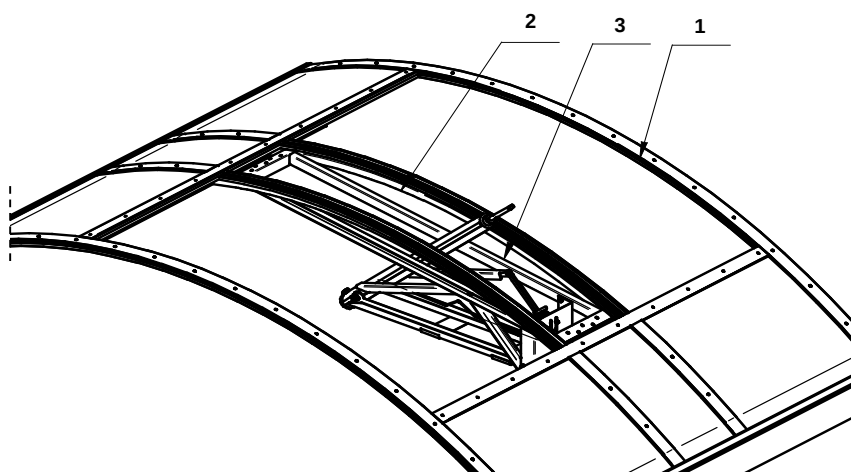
Przykładowe pasmo świetlne przygotowane do montażu klapy
